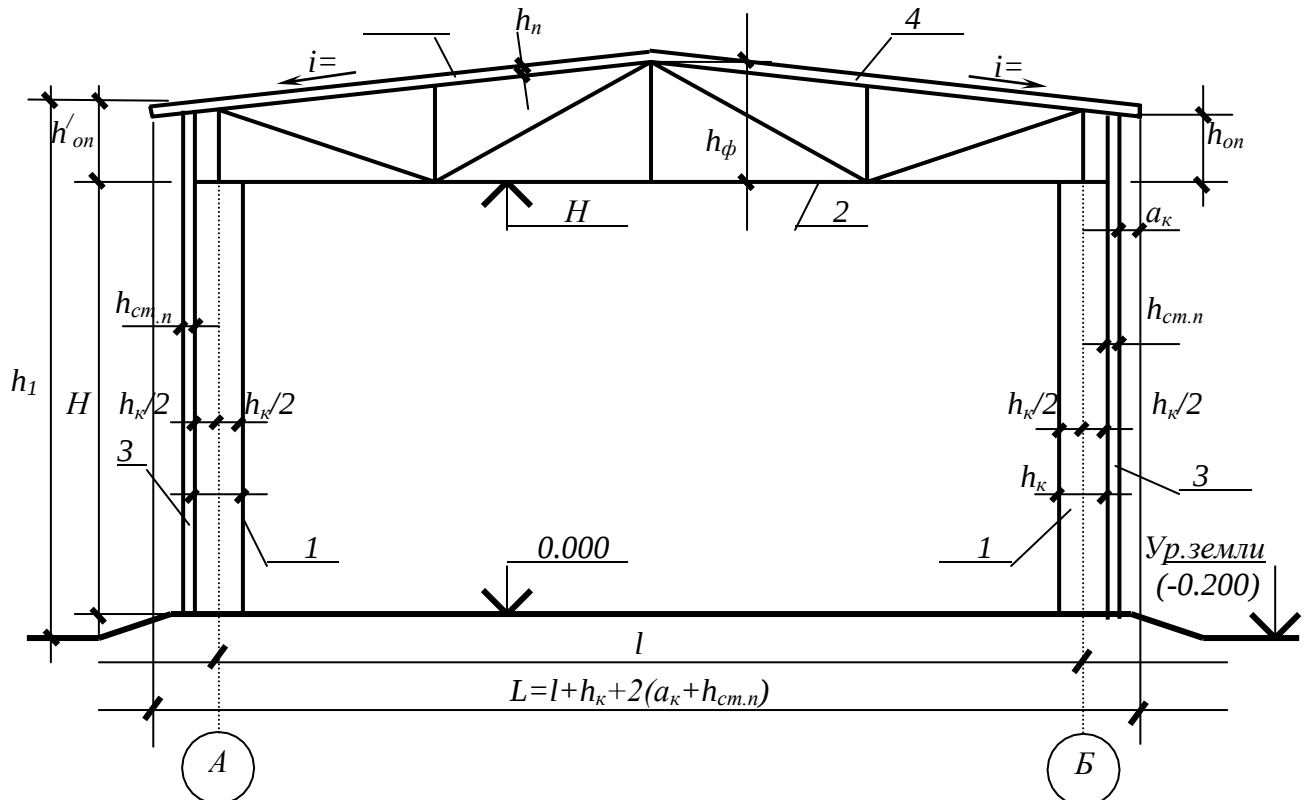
Конструктивная схема поперечной рамы здания: 1 – стойка (колонна); 2 – ферма; 3 – стеновые панели; 4 – плиты покрытия; 5 – рулонная кровля; H – высота до низа несущей конструкции (длина стойки поперечной рамы); h_{ϕ} – высота стропильной фермы в середине пролета (в коньке); h_{on} – высота стропильной фермы на опоре; h_{on}' – высота на опоре с учетом высоты плит покрытия; h_k – высота поперечного сечения стойки (колонны); l – пролет стропильной конструкции; $h_{cm.n}$ – высота сечения стеновых панелей; a_k – вылет карниза
